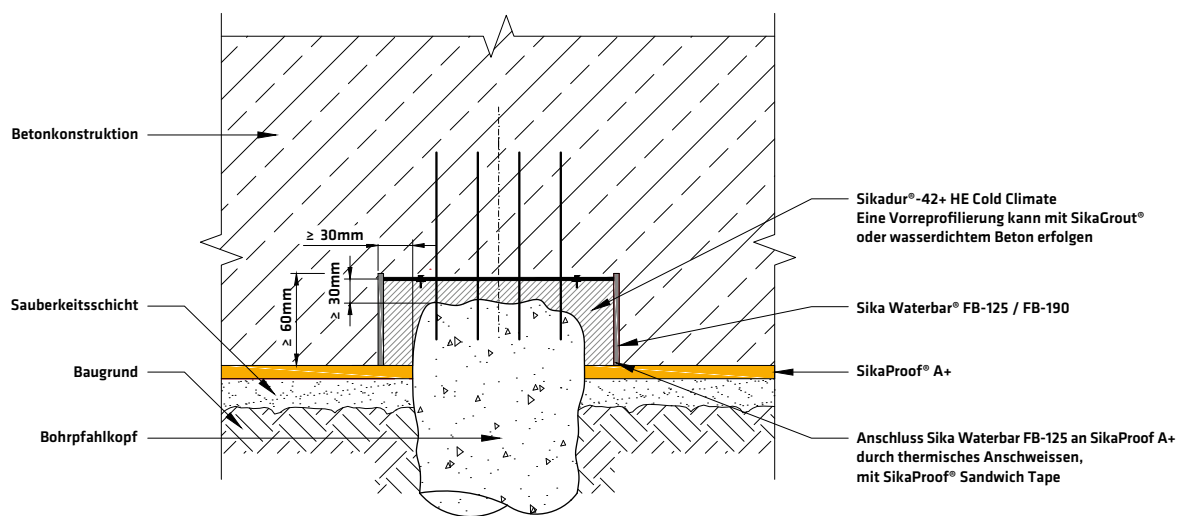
Mikropfahlurchführung (mit Schutzrohr)
